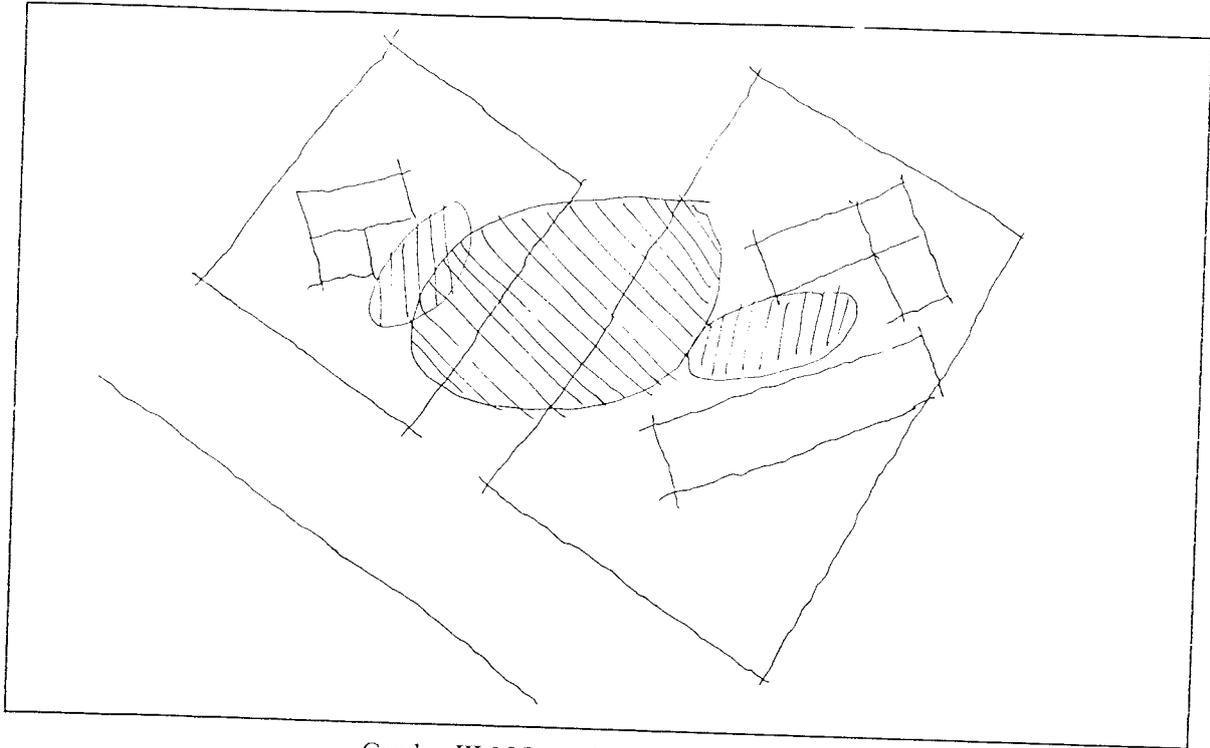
Pengolahan Sirkulasi Dalam Bangunan Sekolah Tinggi Pariwisata
